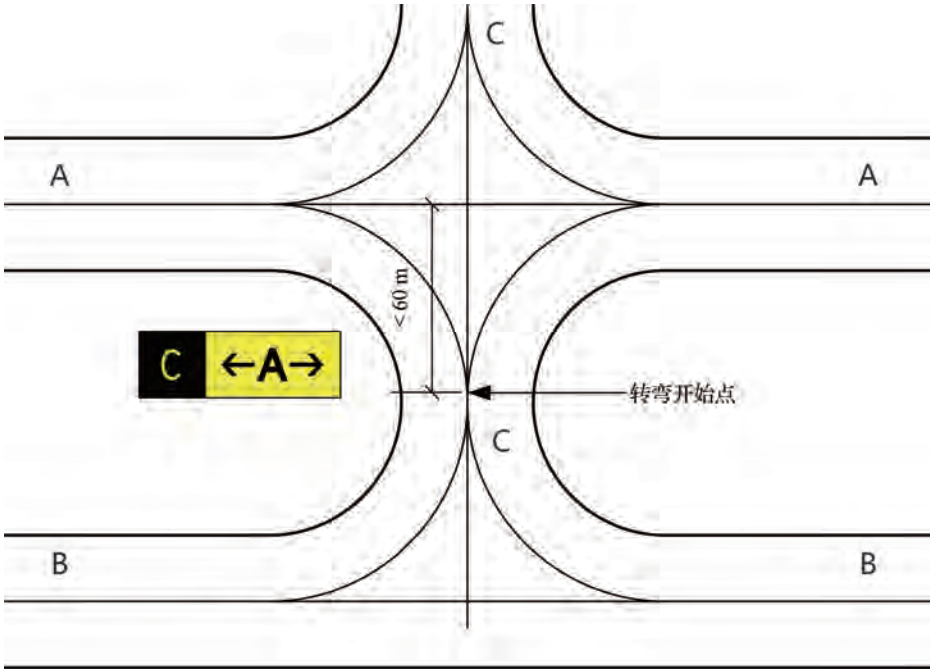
滑行道交叉处标记牌的布置示意图 (四)
